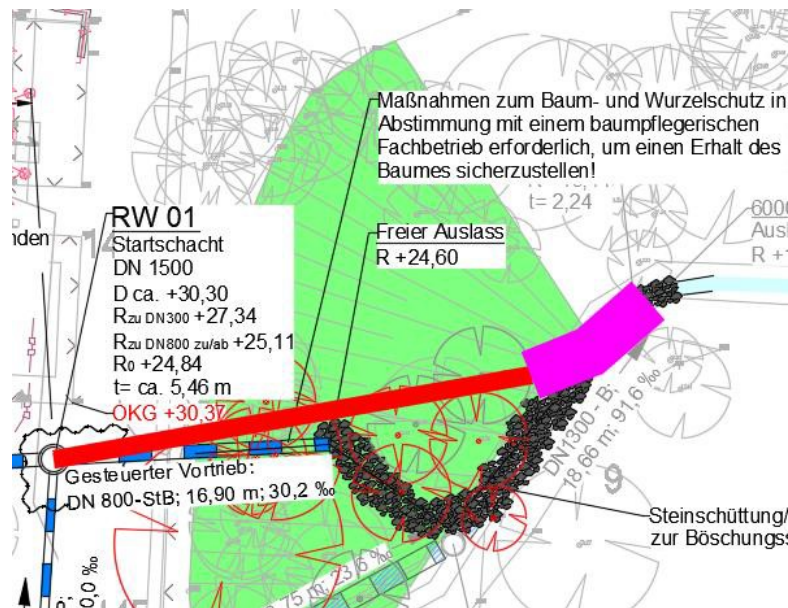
Ausschnitt Lageplan mit dargestellter Vorplanungsvariante 4 (Masuch + Olbrisch 2025a)
